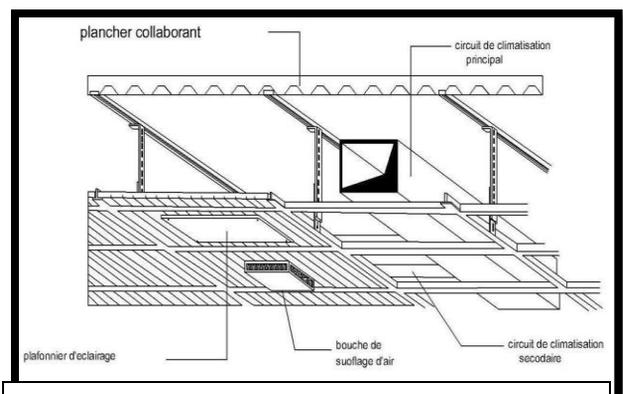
schéma d'un faux plafond de plaque au plâtre /Source : les auteurs
